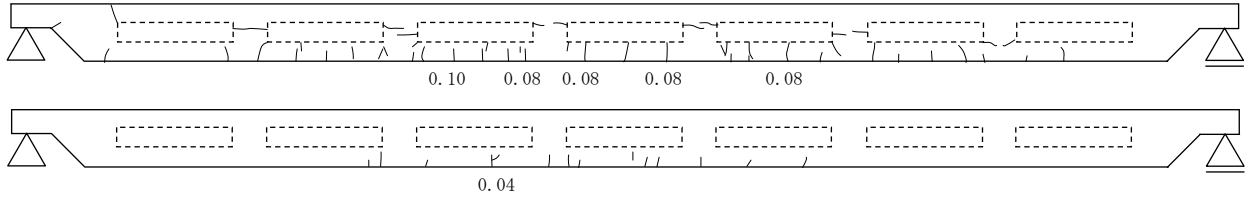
長期荷終了時ひび割れ状況(上段：軽量コンクリート，下段：普通コンクリート，数値はひび割れ幅[mm])
